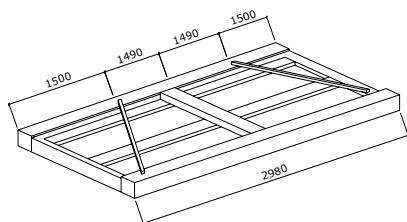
Плита покрытия на деревянном каркасе из клееных профилированных ребер
